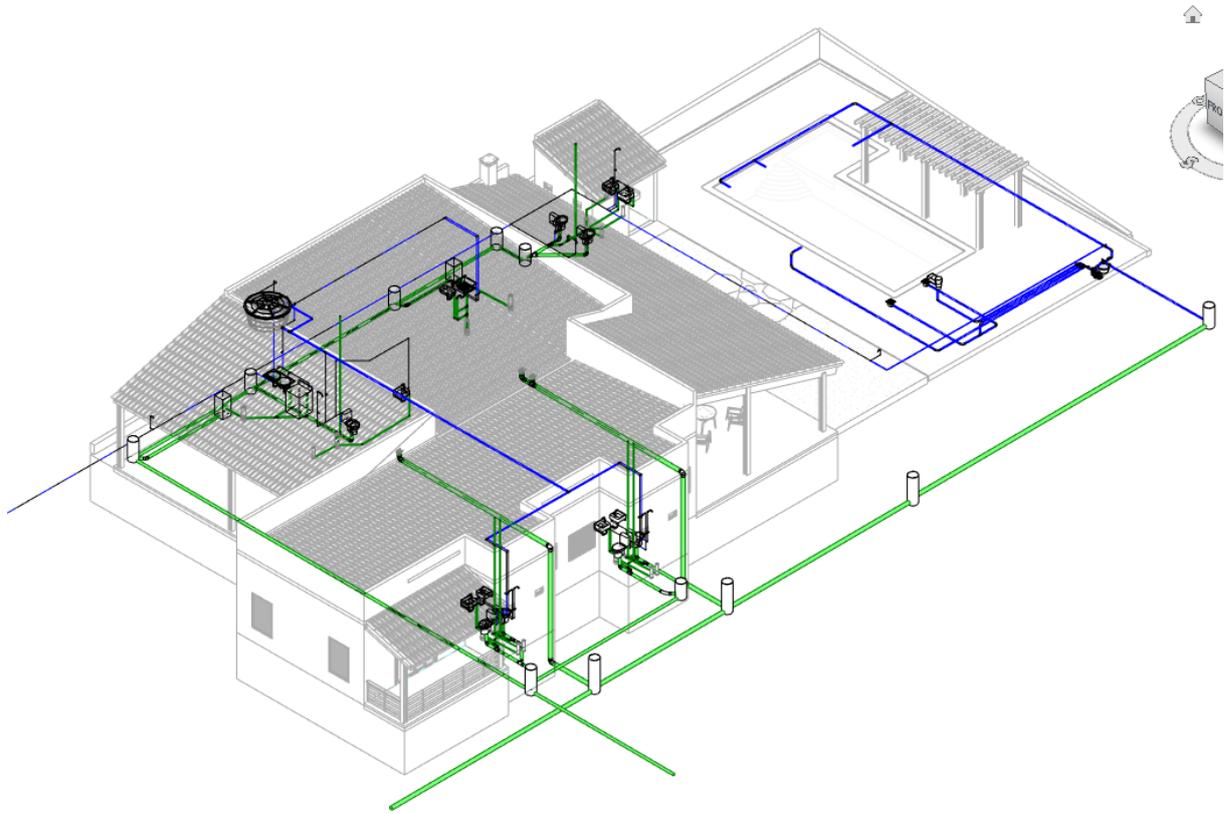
Planta de Coberta Projeto hidrossanitário AutoCad
